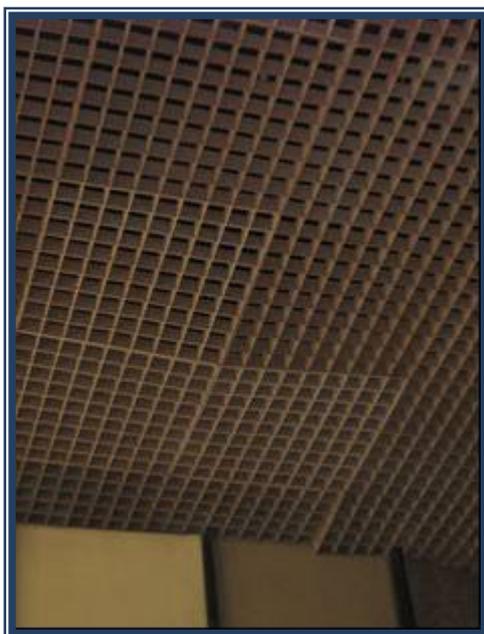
Placas de treliça de madeira desalinhadas no teto da entrada da edificação.
